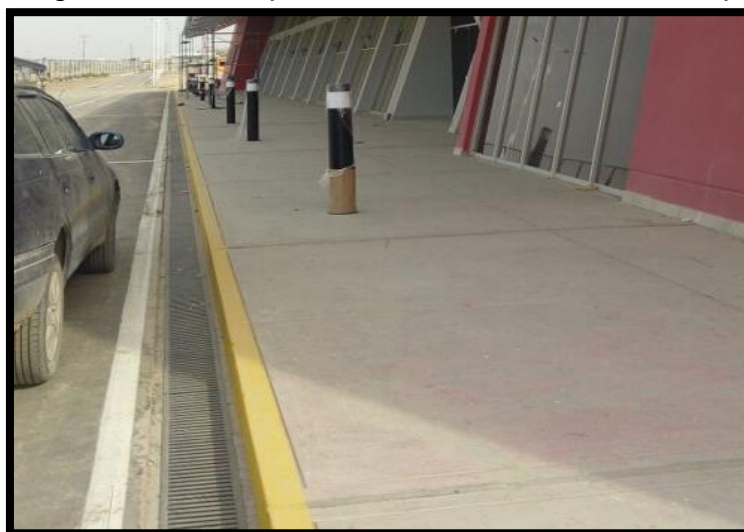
Instalación de rejilla metálica para canaleta pluvial.
